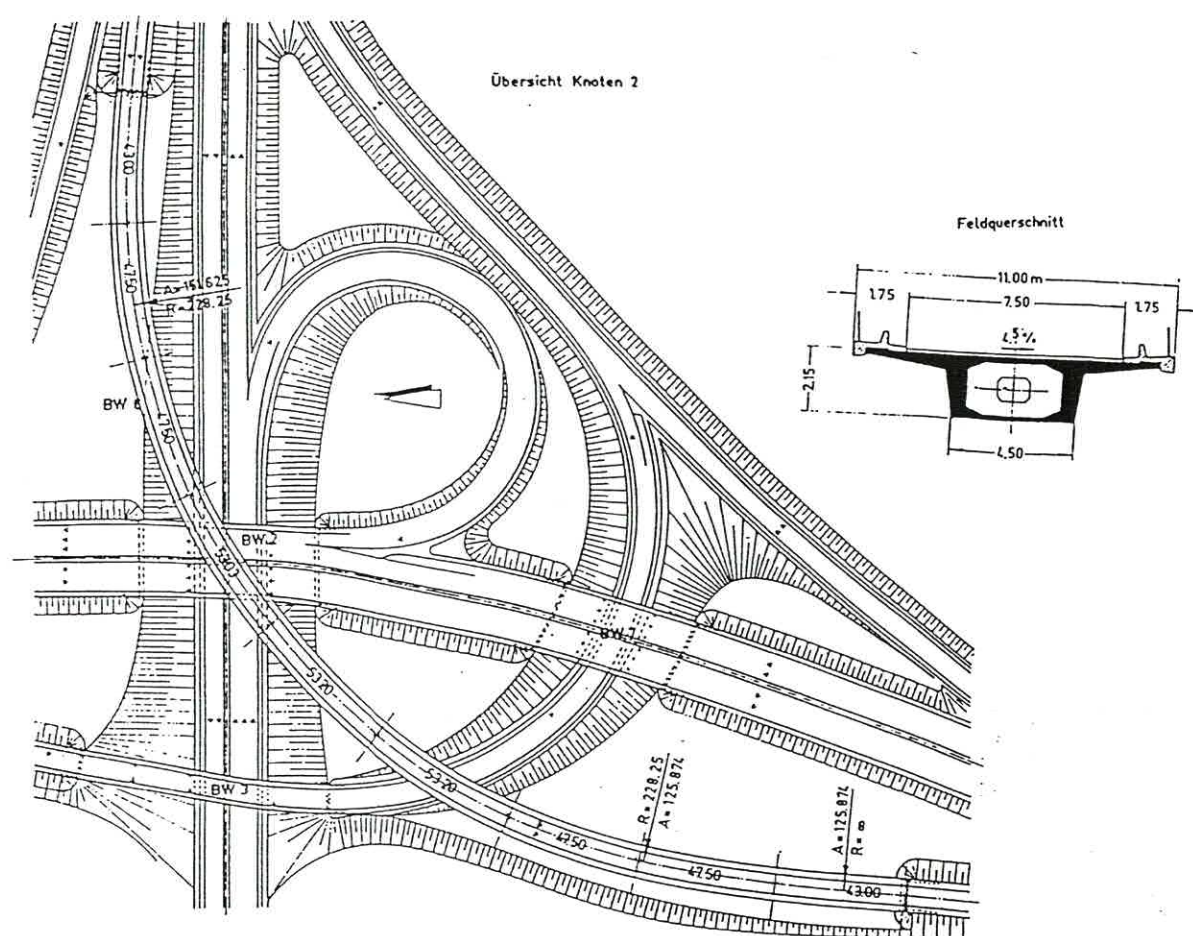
Bauwerk 6 des Straßenknotens 2 im Olympiapark
